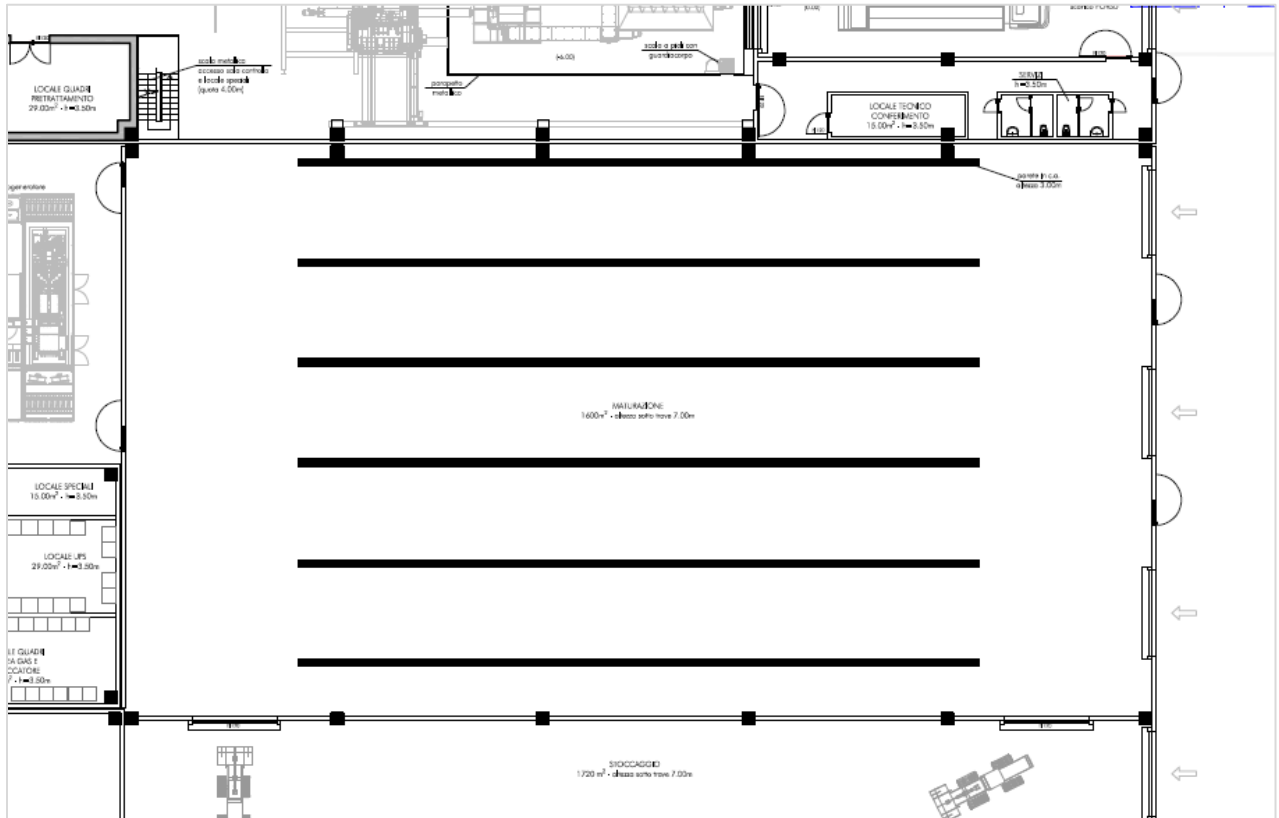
Capannone multifunzione- multimateriale_ Stralcio dalla planimetria generale
